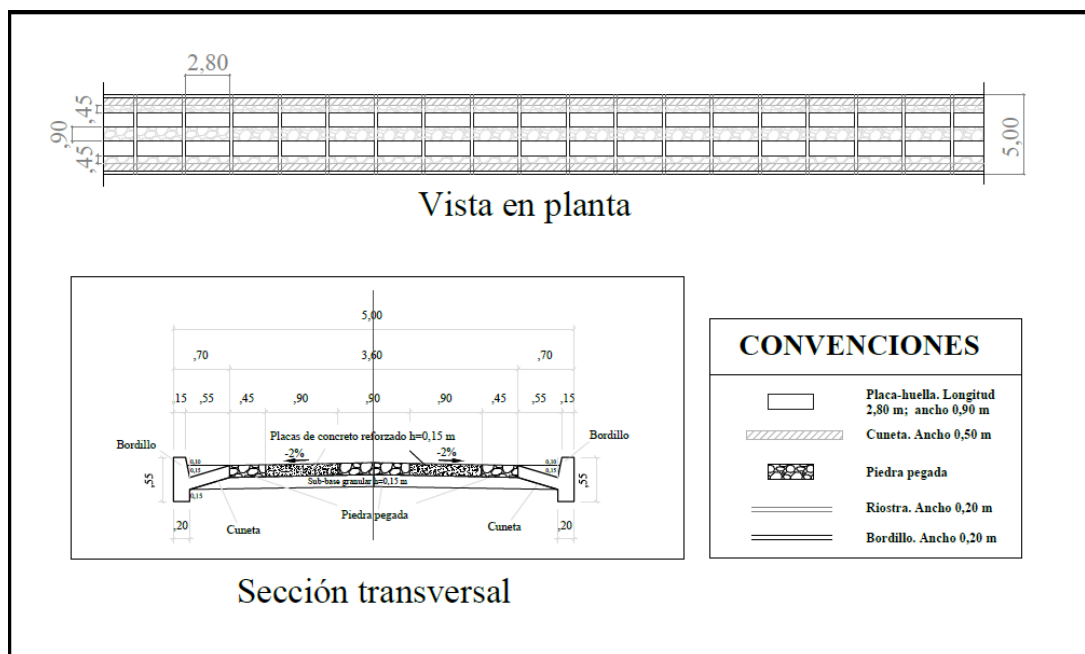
Vista en planta y el perfil de la sección transversal de su tangente
